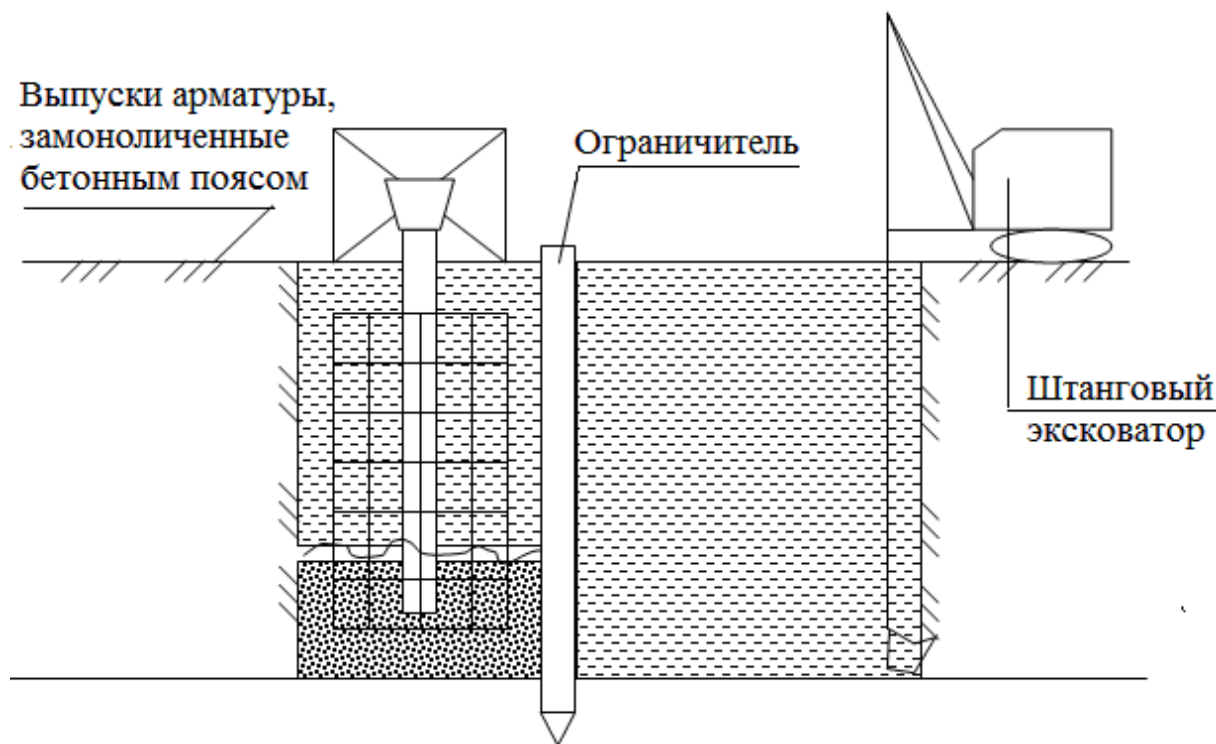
Схема монолитной «стены в грунте» сплошной разработкой траншеи
